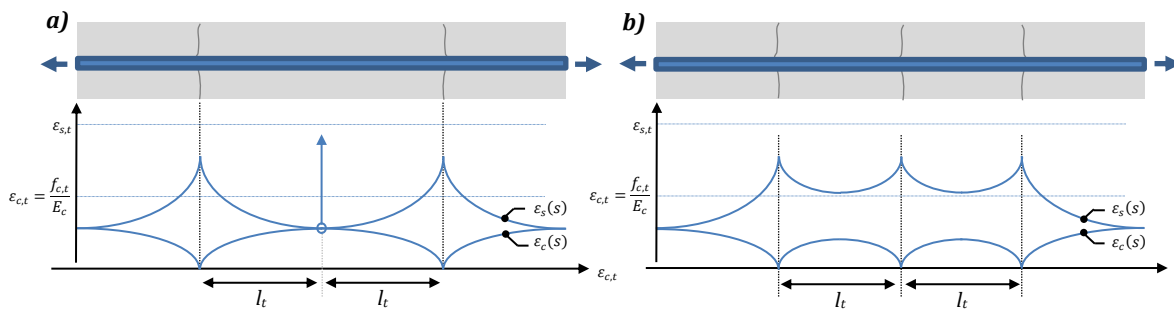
Esquema de las deformaciones en el hormigón y la armadura convencional para a) justo antes de la aparición de una nueva fisura y b) fase final de la fisuración
